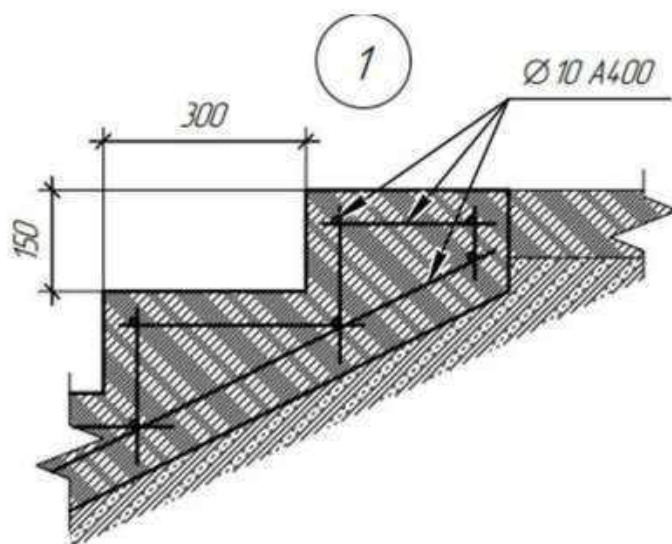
Узел армирования лестничного спуска (ступеней) в подвал
